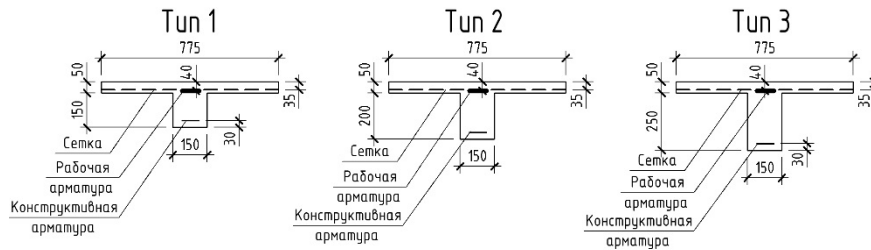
б. Вариант 2. Расчетные сечения для определения пролетного армирования
